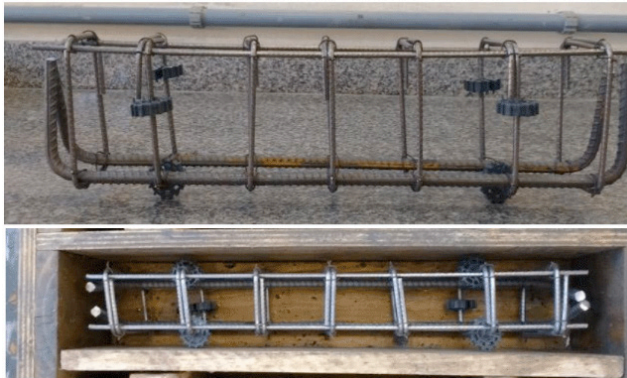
Armadura V02 com estribos convencionais 1 Ø 5,0 mm c/ 7,5 cm.
